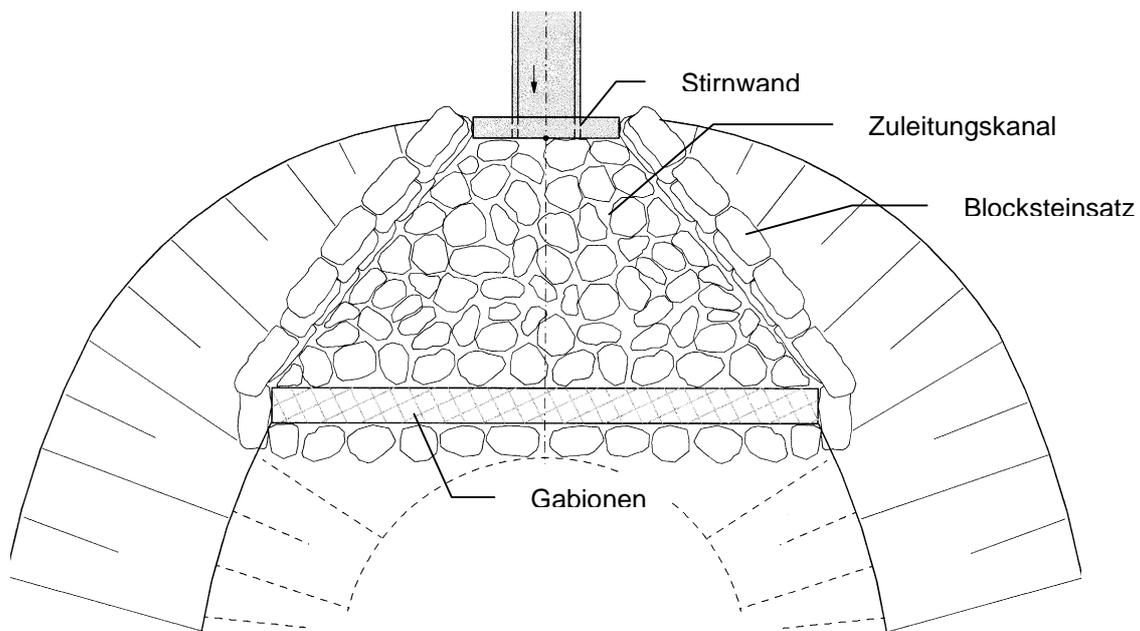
Punktförmiges Zulaufbauwerk mit Tosbecken
